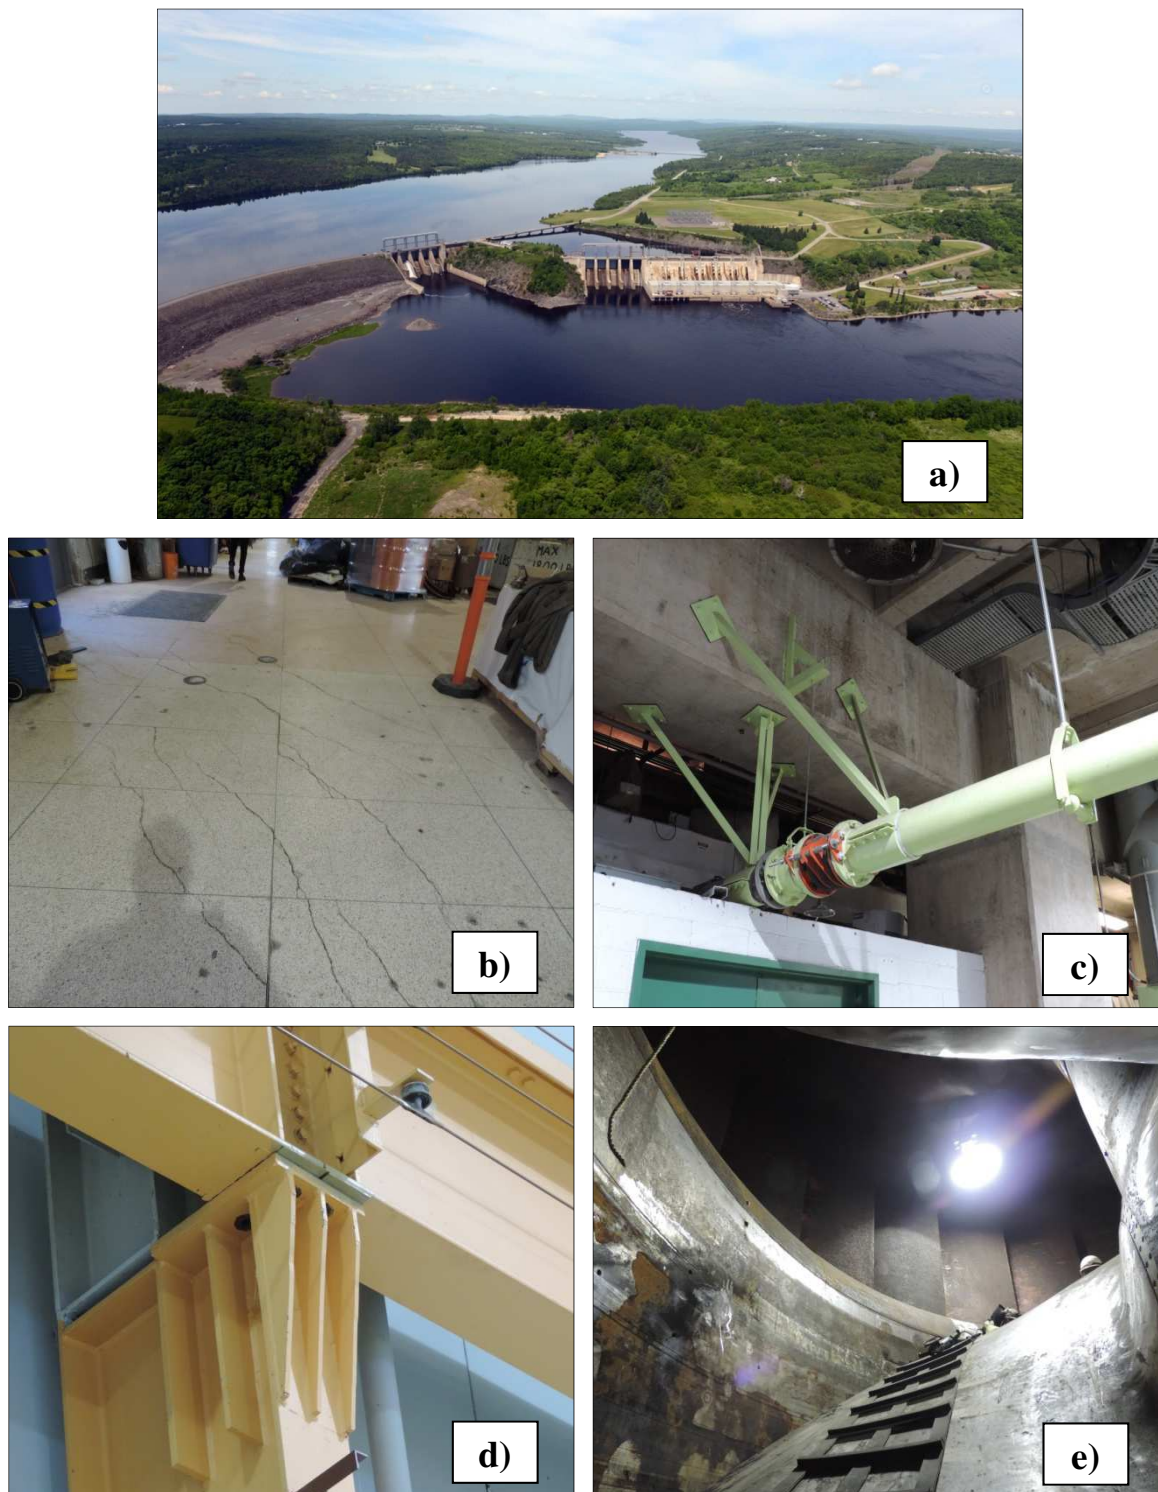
Mactaquac: a) Vista geral; b) Fissura no piso do gerador; c) Junta expansível na tubulação; d) Pilar da ponte rolante com prumo desalinhado no encontro apoio/viga; e) Blindagem da sucção raspada pela pá do rotor (AUTOR/NB POWER)
